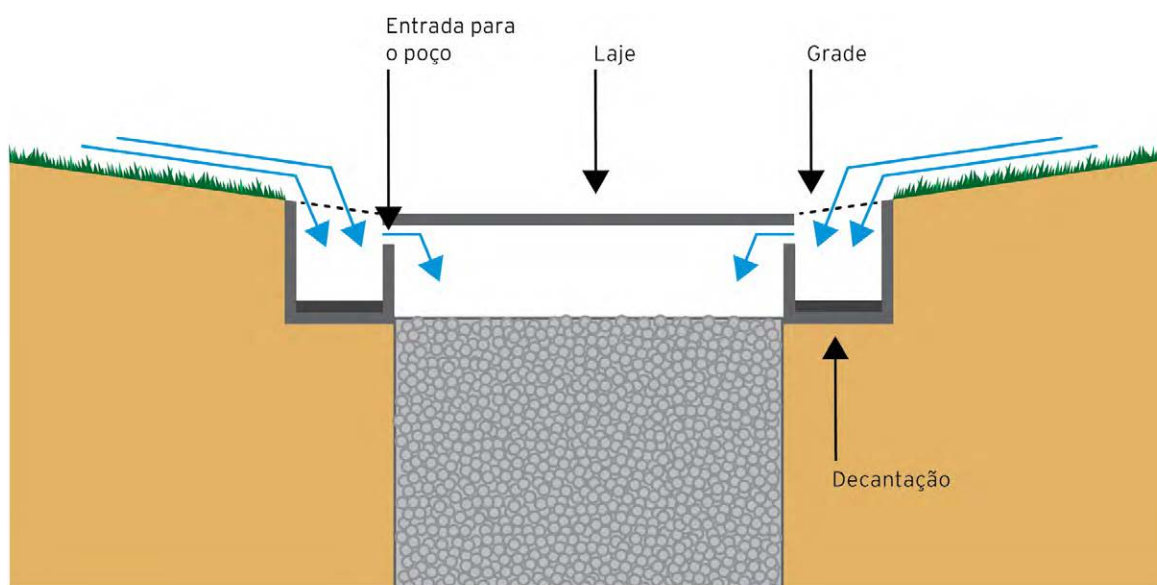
Corte transversal típico de uma trincheira de infiltração.
